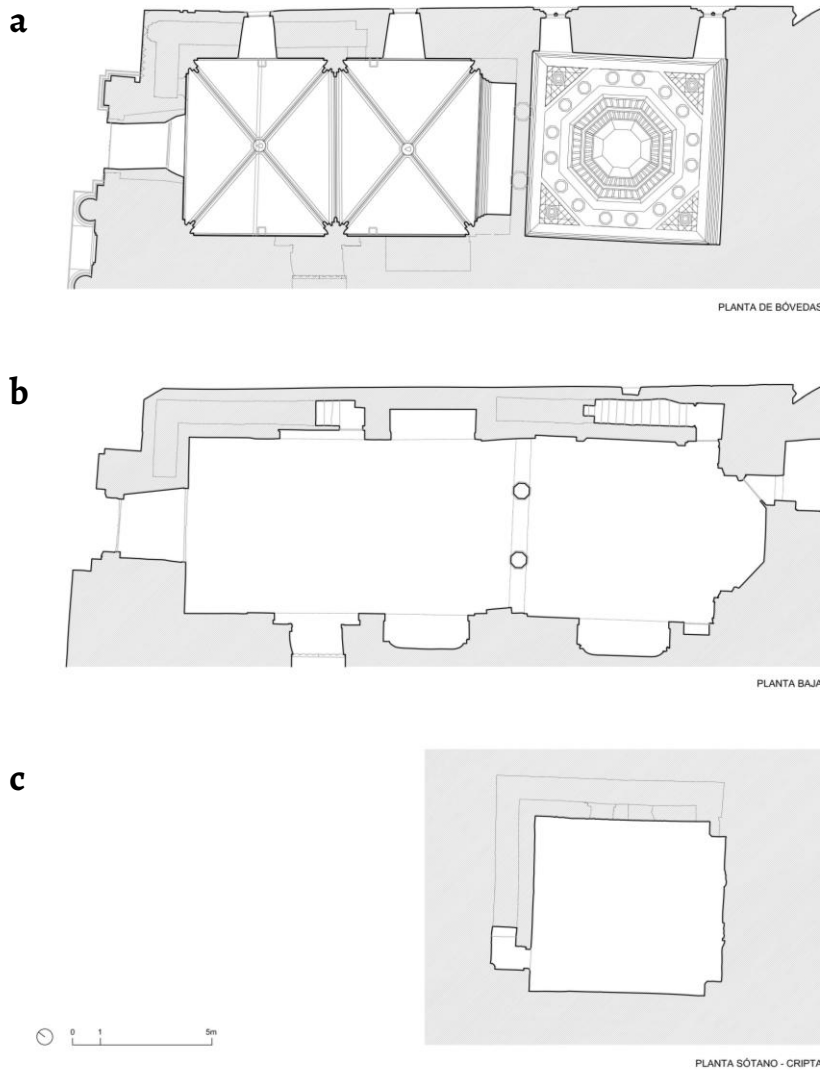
Plantas obtenidas a partir de delineado sobre la nube de puntos: a) planta de bóvedas; b) planta baja; c) planta sótano – cripta.
